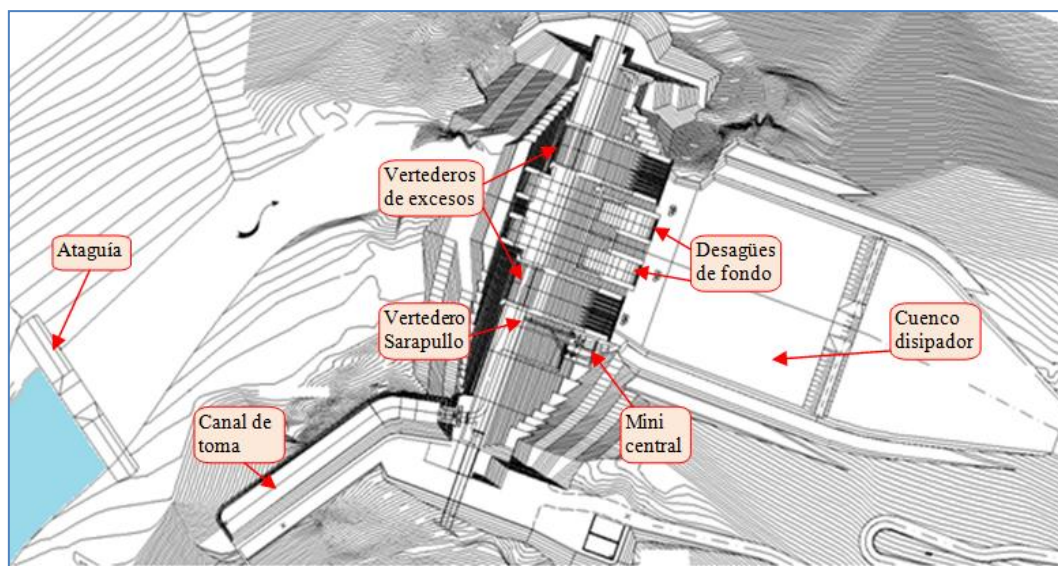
Planta de la Presa Toachi y sus obras complementarias
